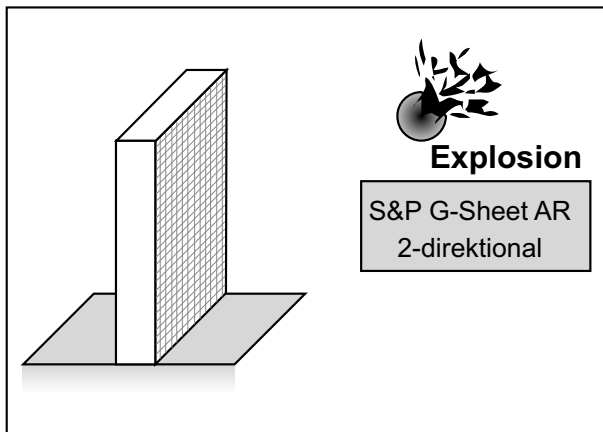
Schutz von explosionsgefährdeten Bauteilen
